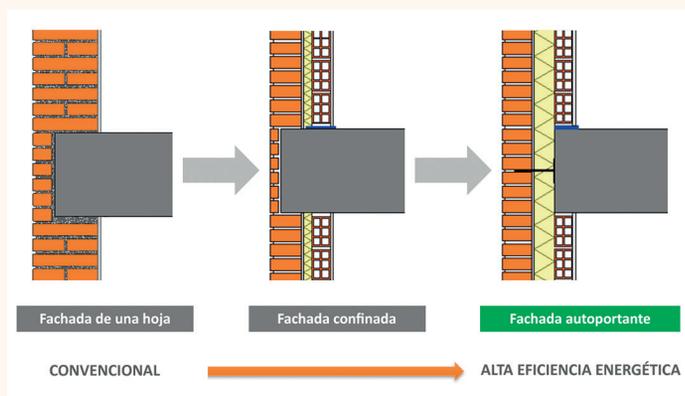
Evolución de las fachadas de ladrillo cara vista.
